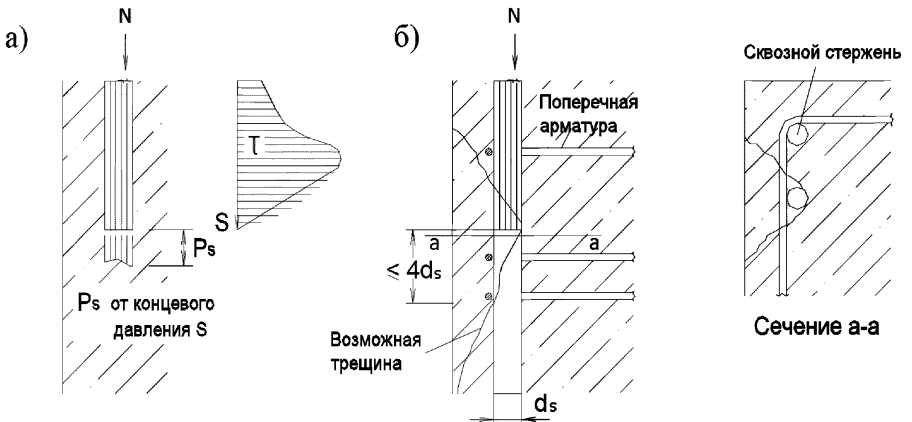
Предотвращение опасности раскалывания из-за давления торцов сжатых стержней посредством поперечной арматуры, охватывающей сквозные продольные стержни: a – давление на бетон под торцом арматуры; b – расположение поперечной арматуры в опорной зоне
